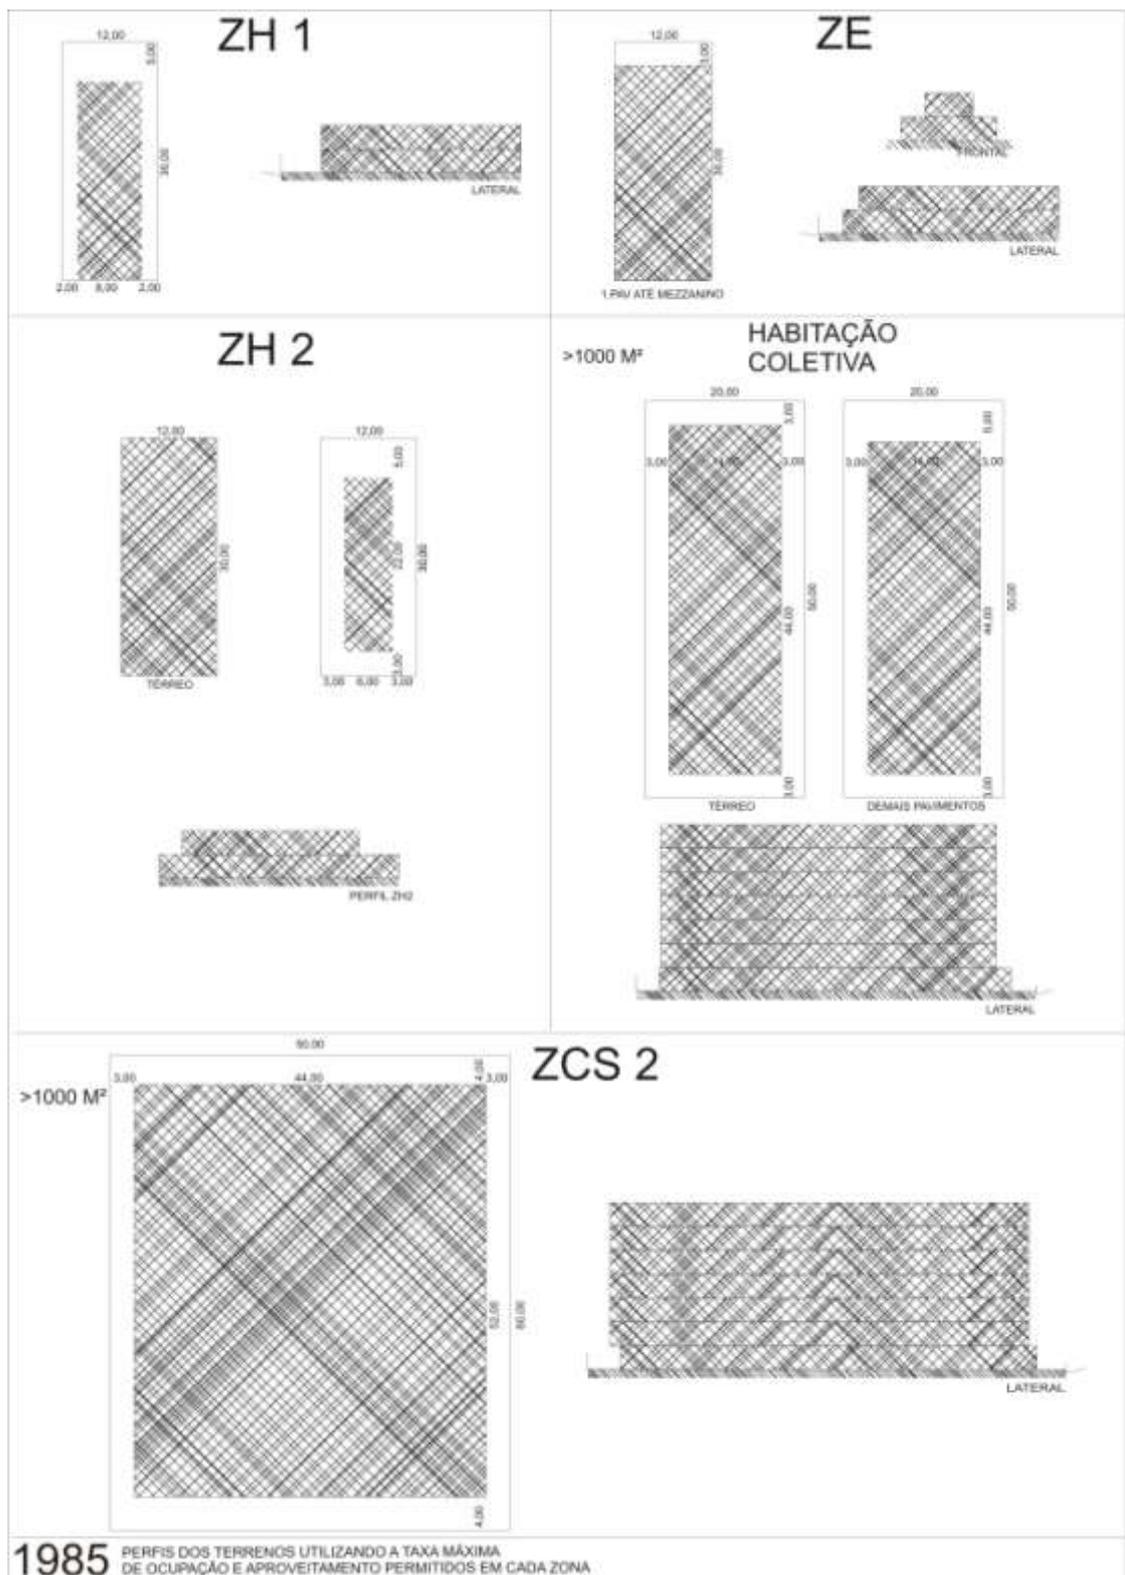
Perfil tipológico proposto pelo Plano Diretor de 1985- manchas esquemáticas
